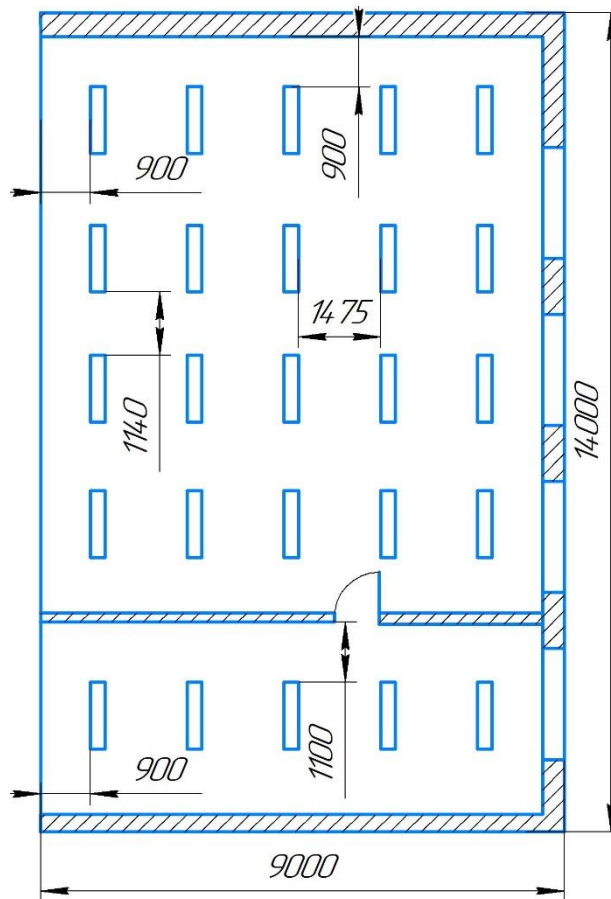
План помещения и размещения светильников с люминесцентными лампами
